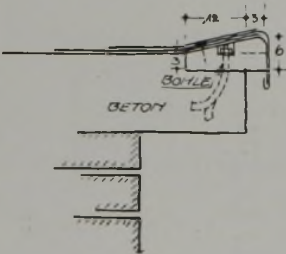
Orteindeckung mit stärkerem Ueberhang, sonst wie Abb. 13.
